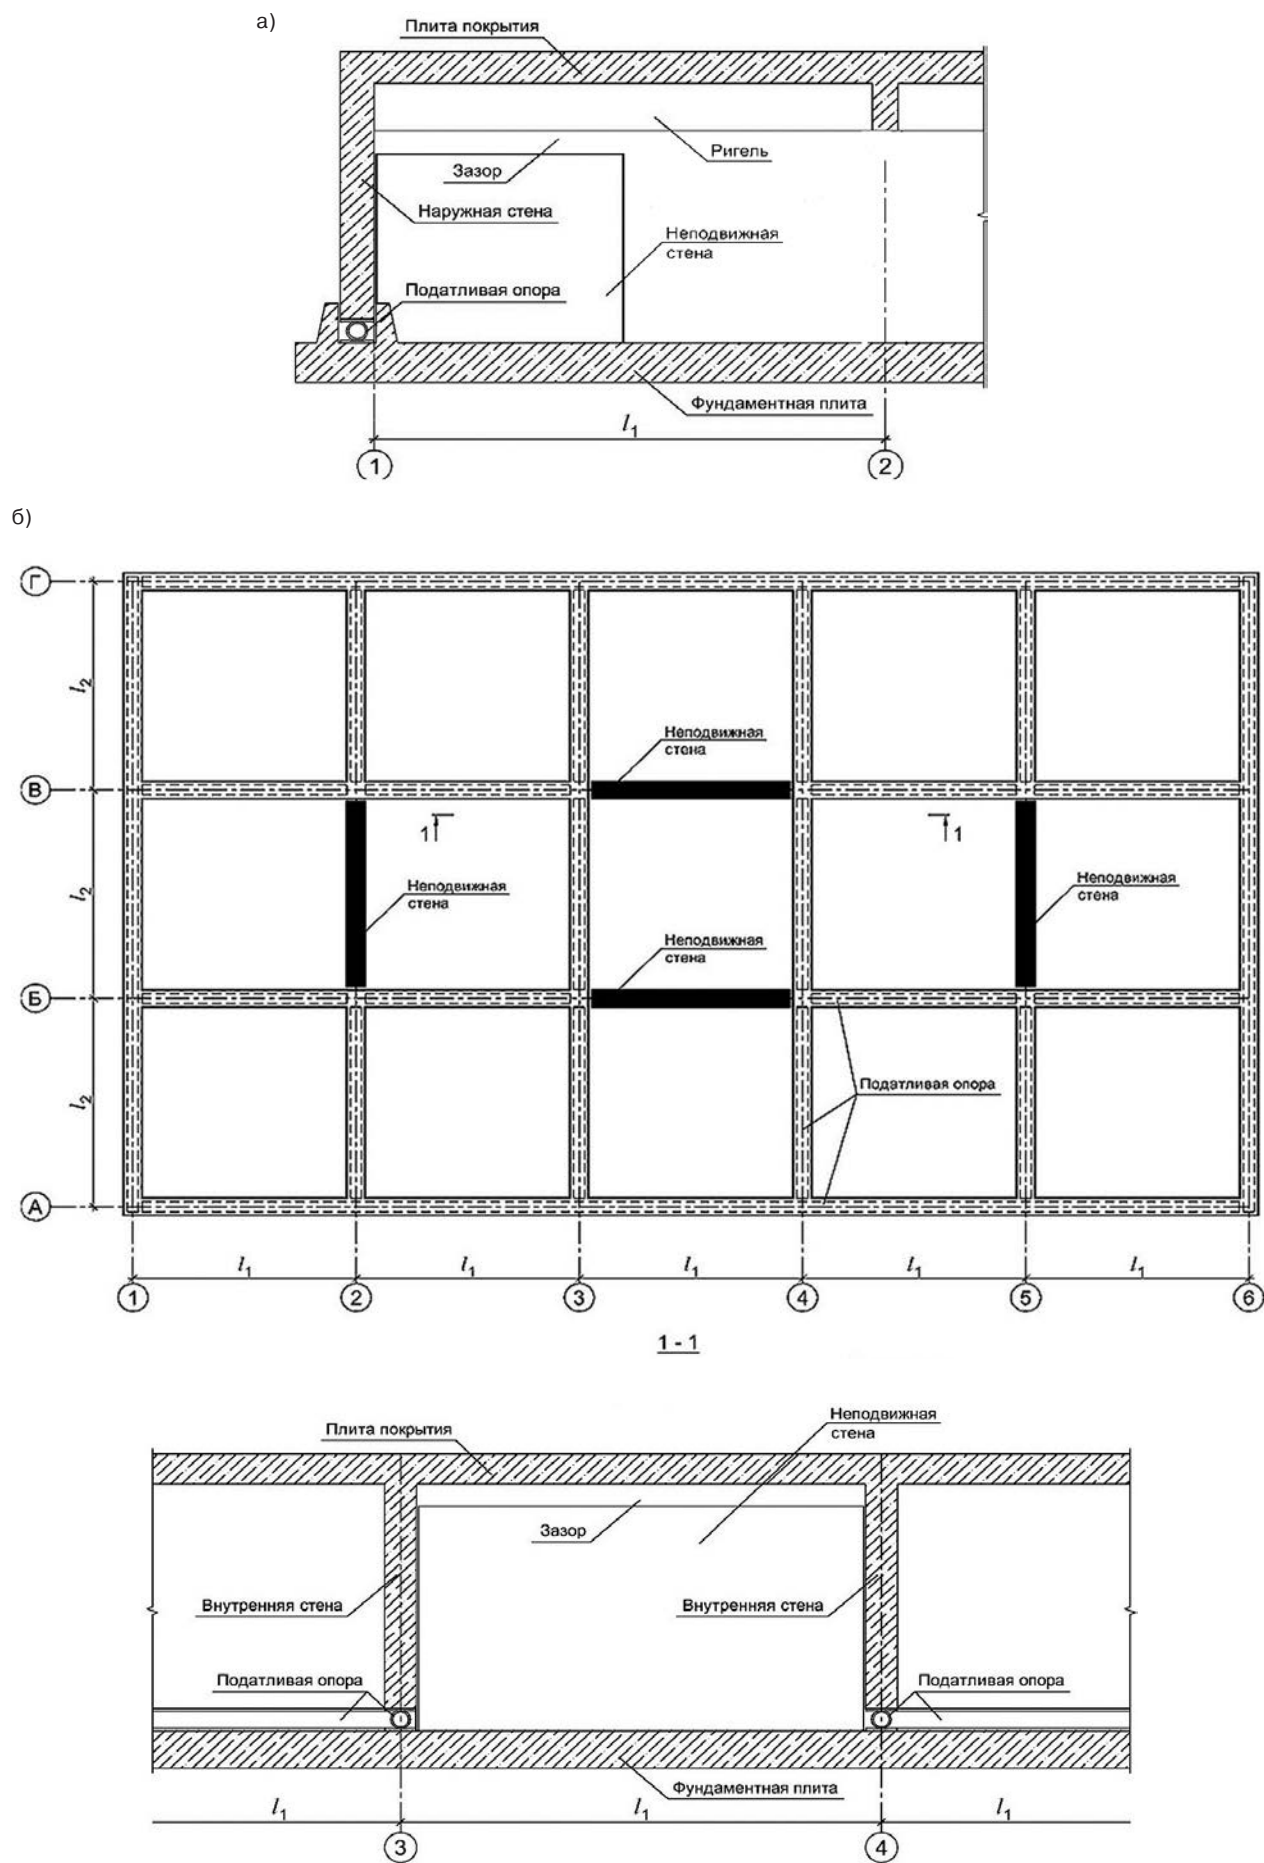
Схема расстановки податливых опор и неподвижных стен для восприятия горизонтальной динамической нагрузки: а) у наружной стены; б) в середине убежища
